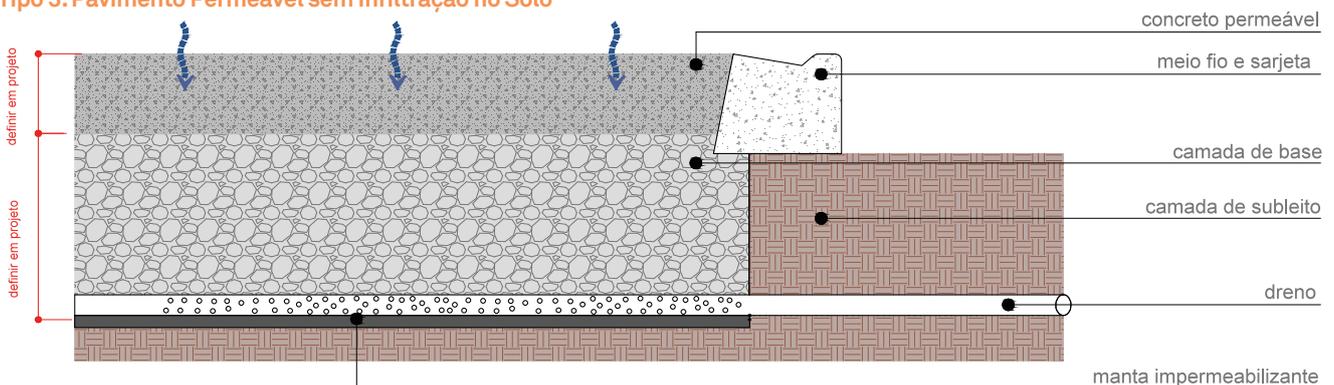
Esquema técnico de pavimento permeável sem infiltração no solo.
